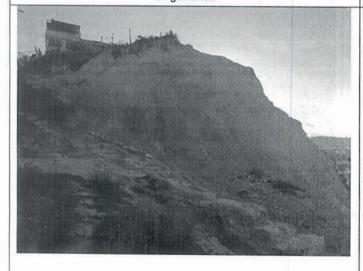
Vista actual desde la parte baja de la ladera que fue intervenida.
